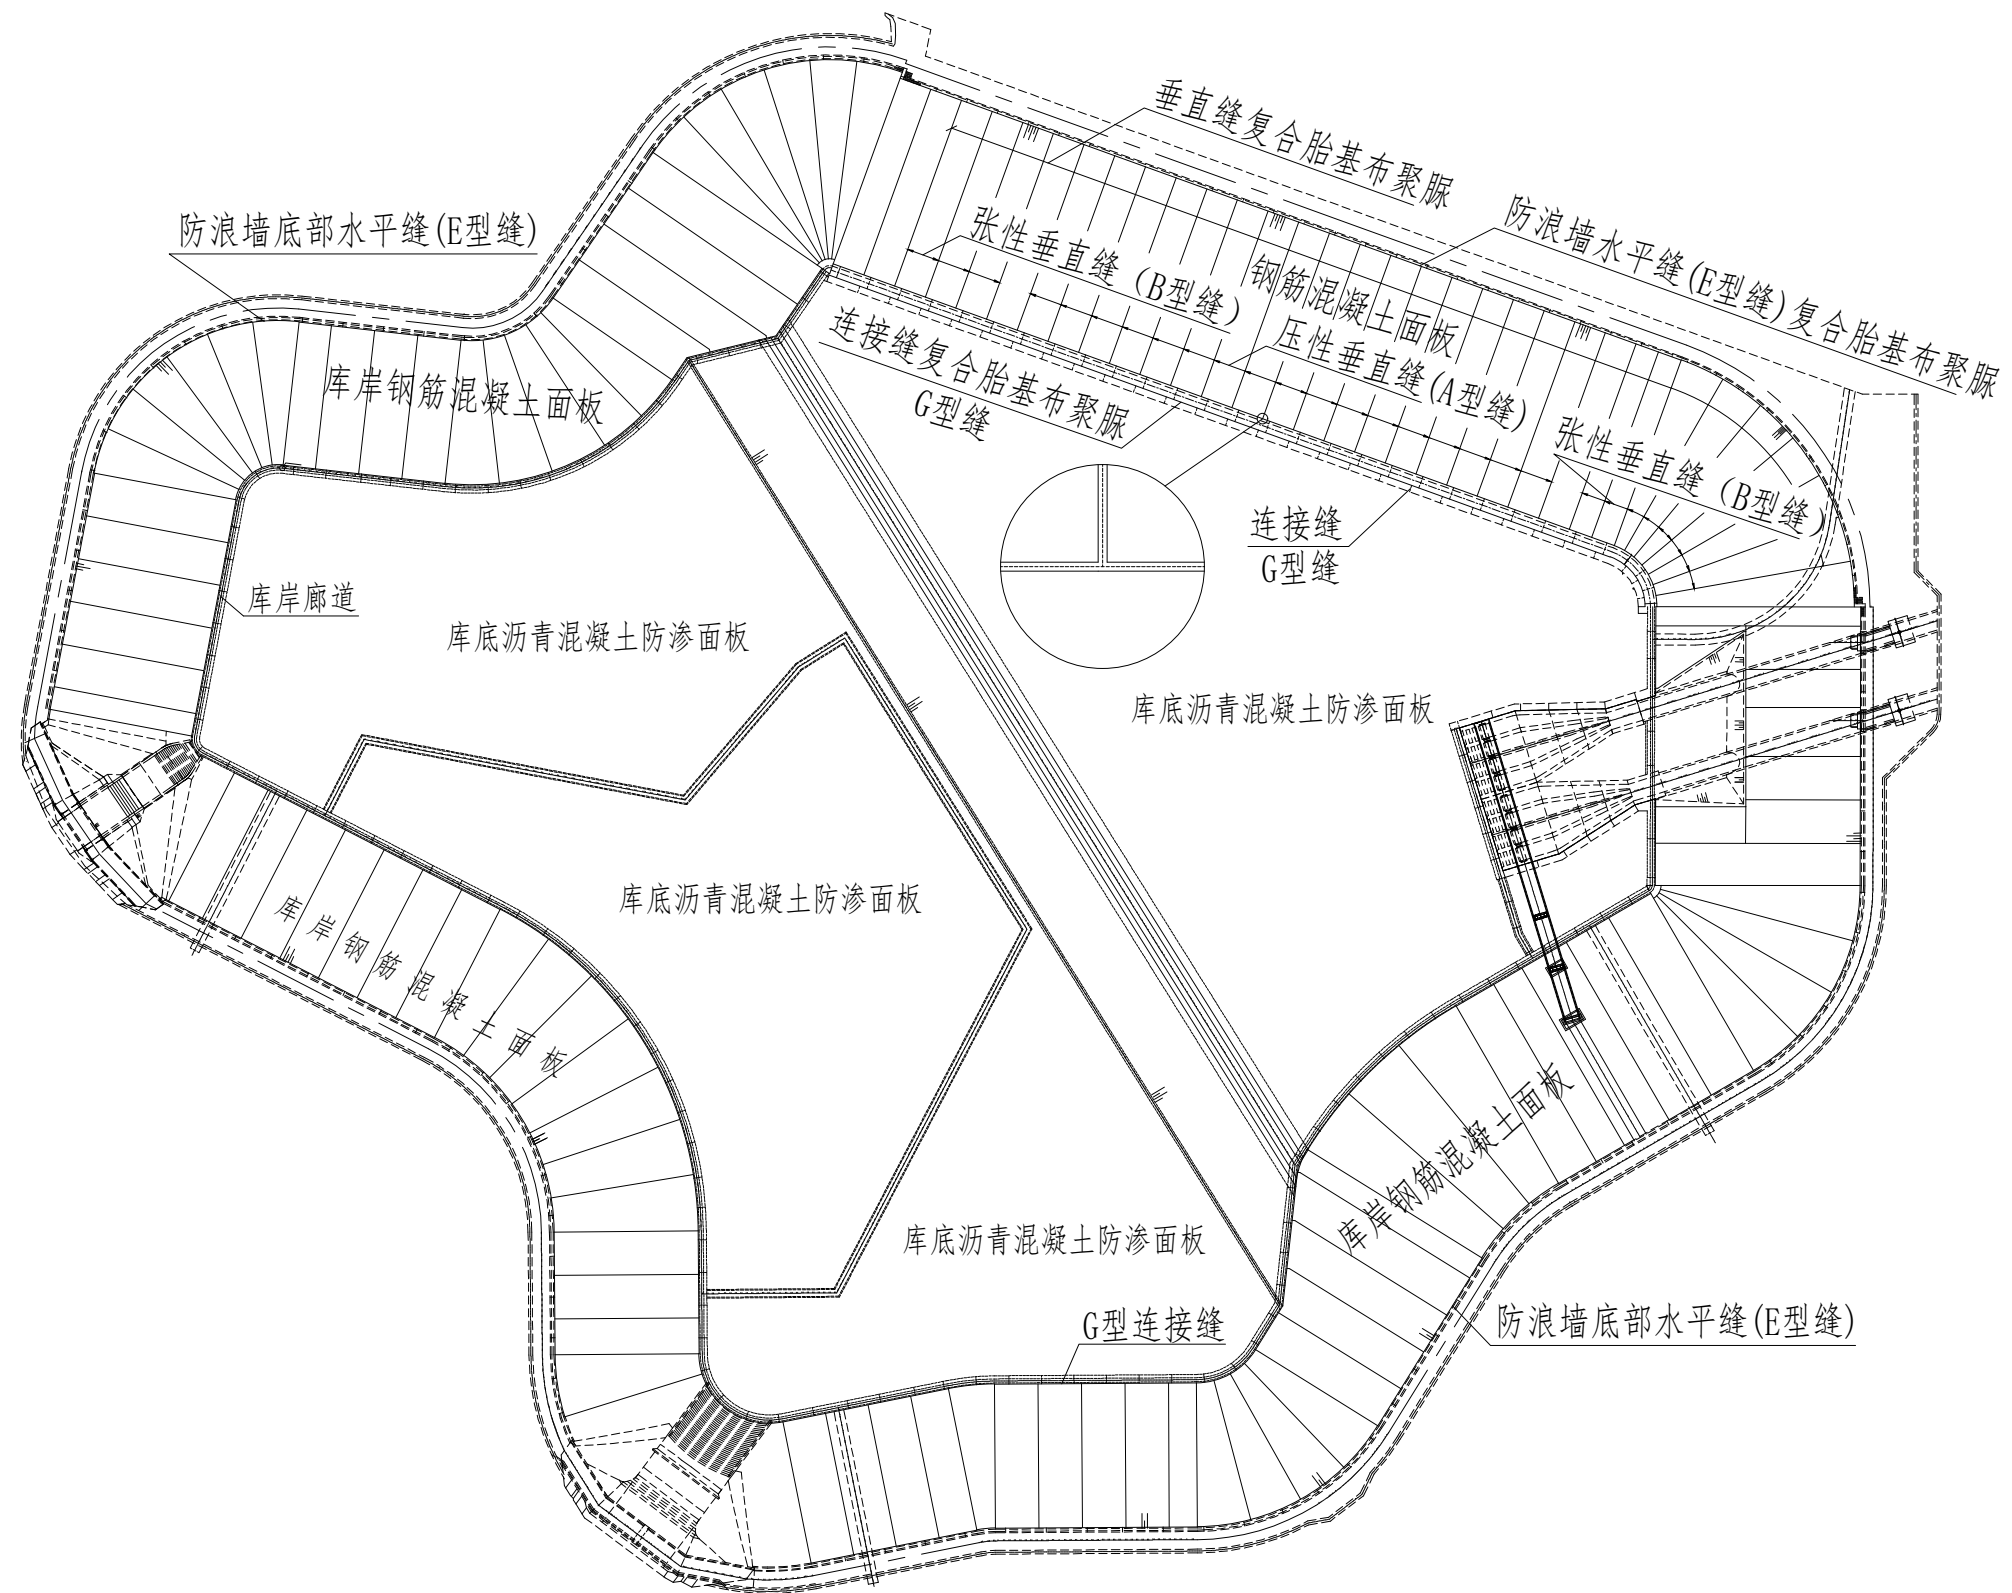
抽水蓄能面板堆石坝表面涂覆平面布置图
